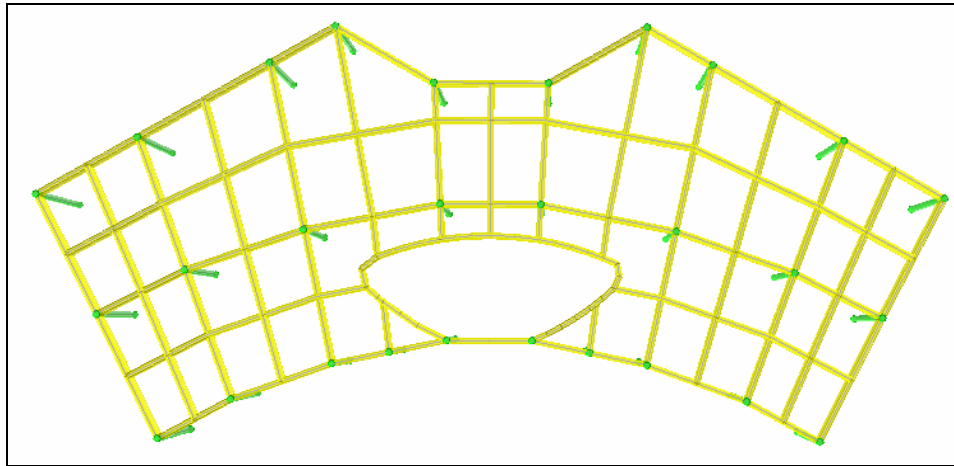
Distribución de vigas y columnas para la platea baja.
